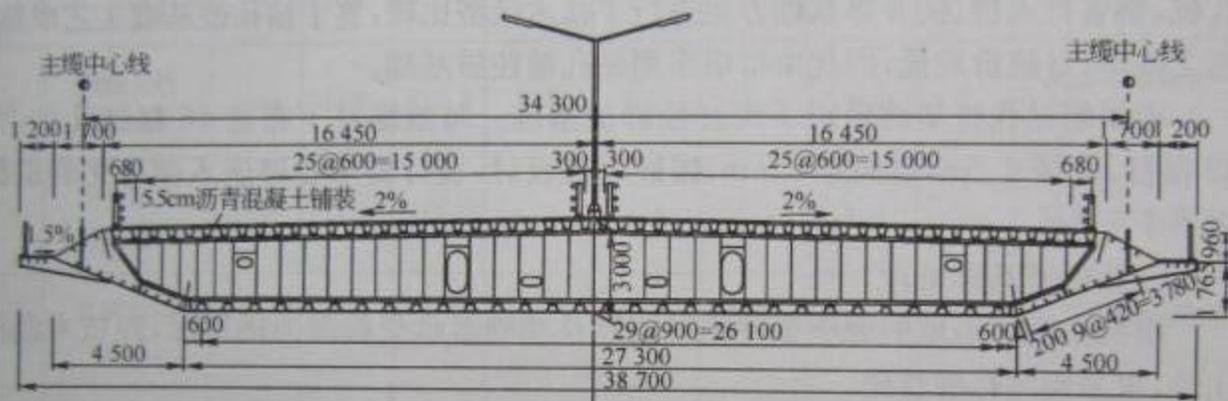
加劲梁横截面构造(尺寸单位:mm)
